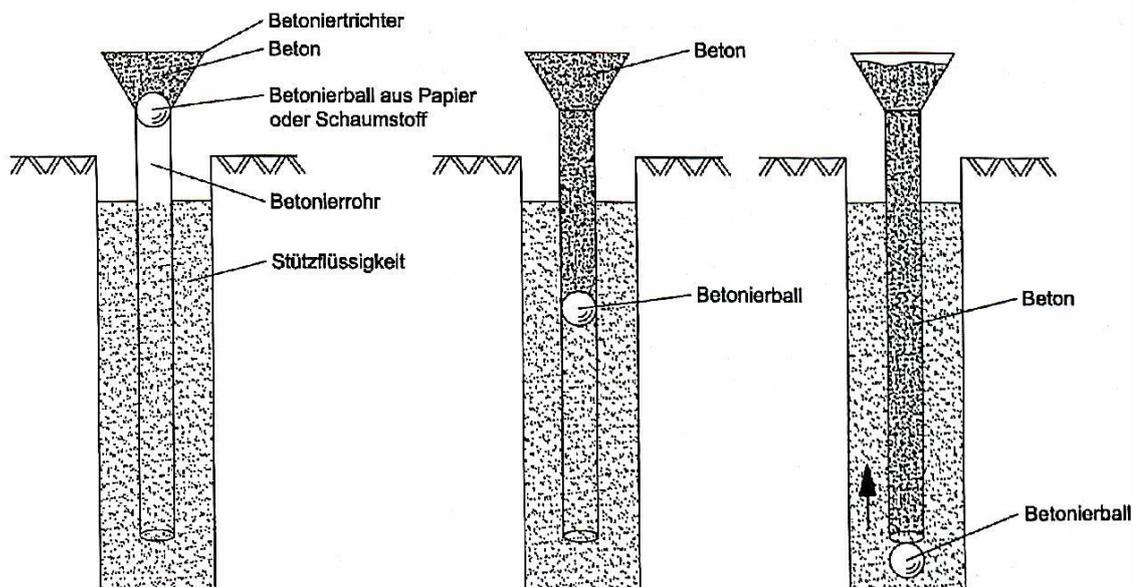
Kontraktorverfahren mit dem Betonierball [17]
